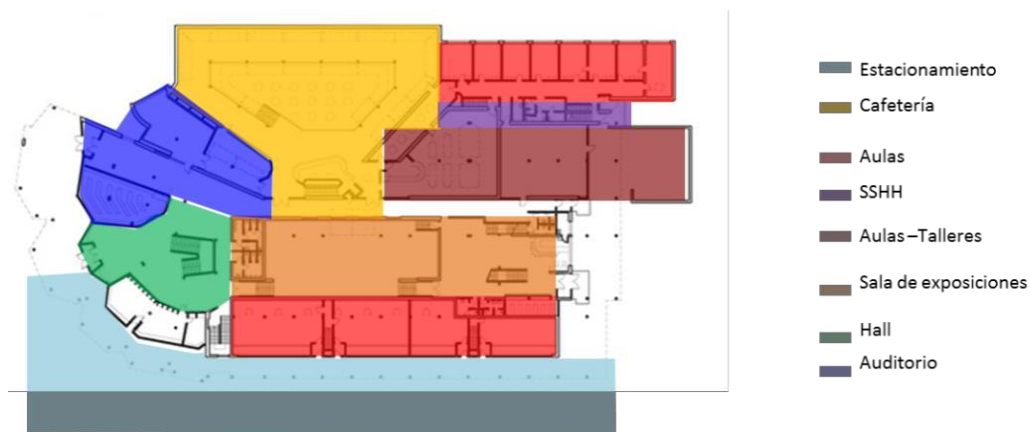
Primera Planta con la Descripción del Sistema Espacial
